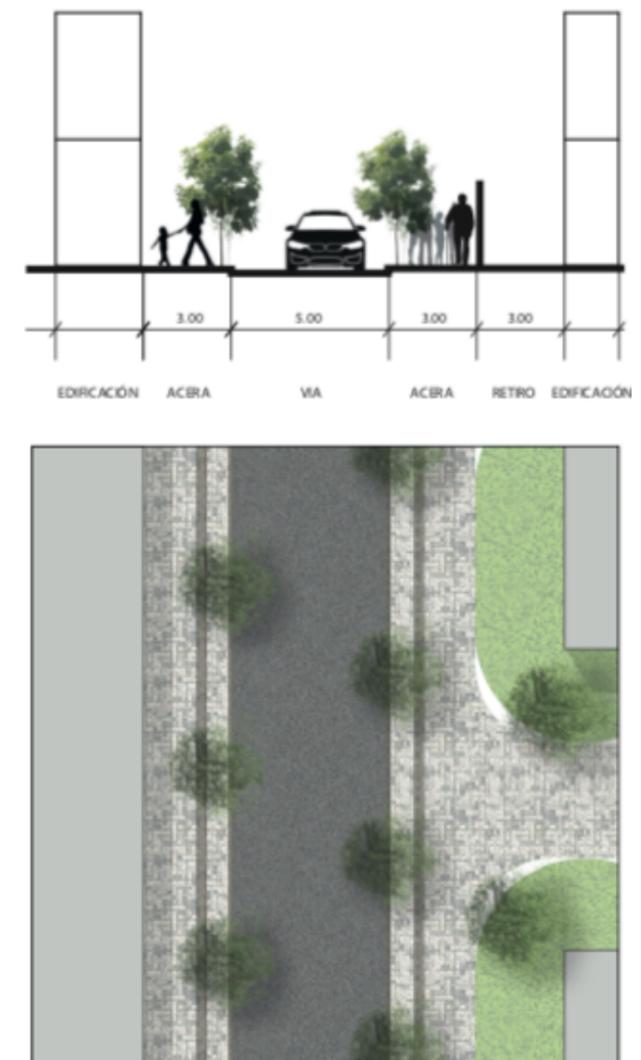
Corte calle Cochapata. Tomada de Master Plan “El Batán”
